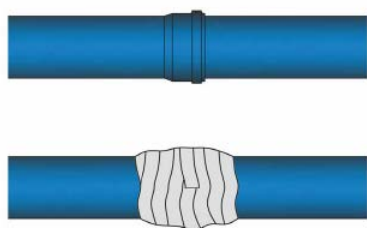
Foto Protezione della connessione della presa dalla posa del calcestruzzo
